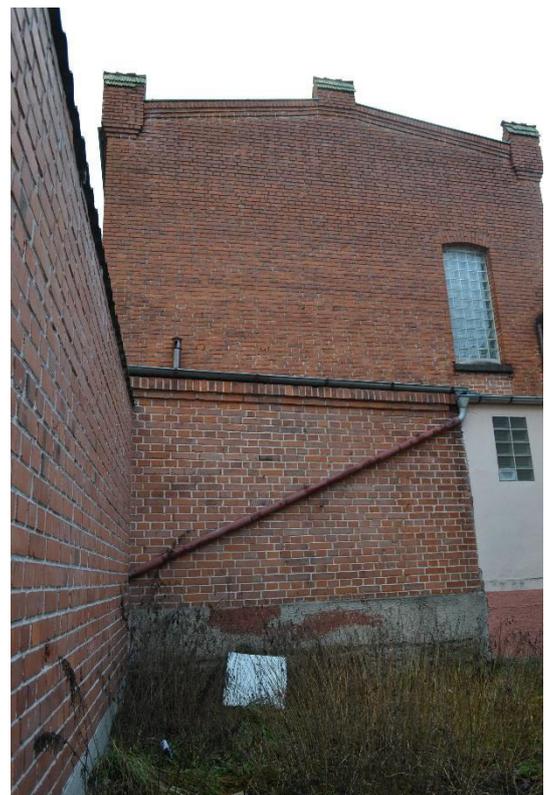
Hinter den Garagen, westlich an das Backsteingebäude angrenzend, befindet sich eine kleine, verwilderte Grünfläche.
